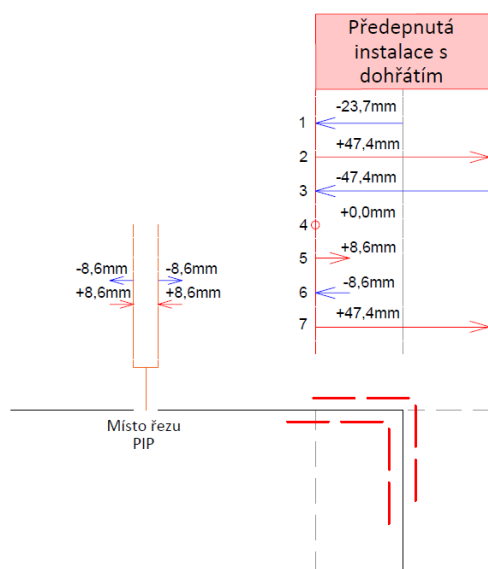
Příklad dilatačního místa tepelně předepnuté instalace s provedením opravy potrubí rozříznutím a vložením mezikroužku
